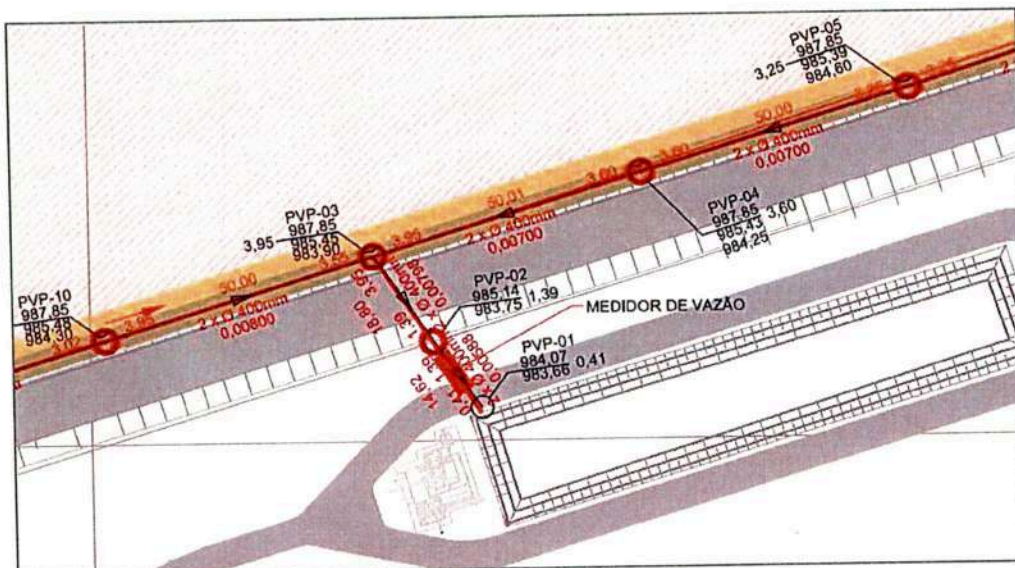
Detalhe do projeto da implantação da 2ª etapa prancha 07/21.
